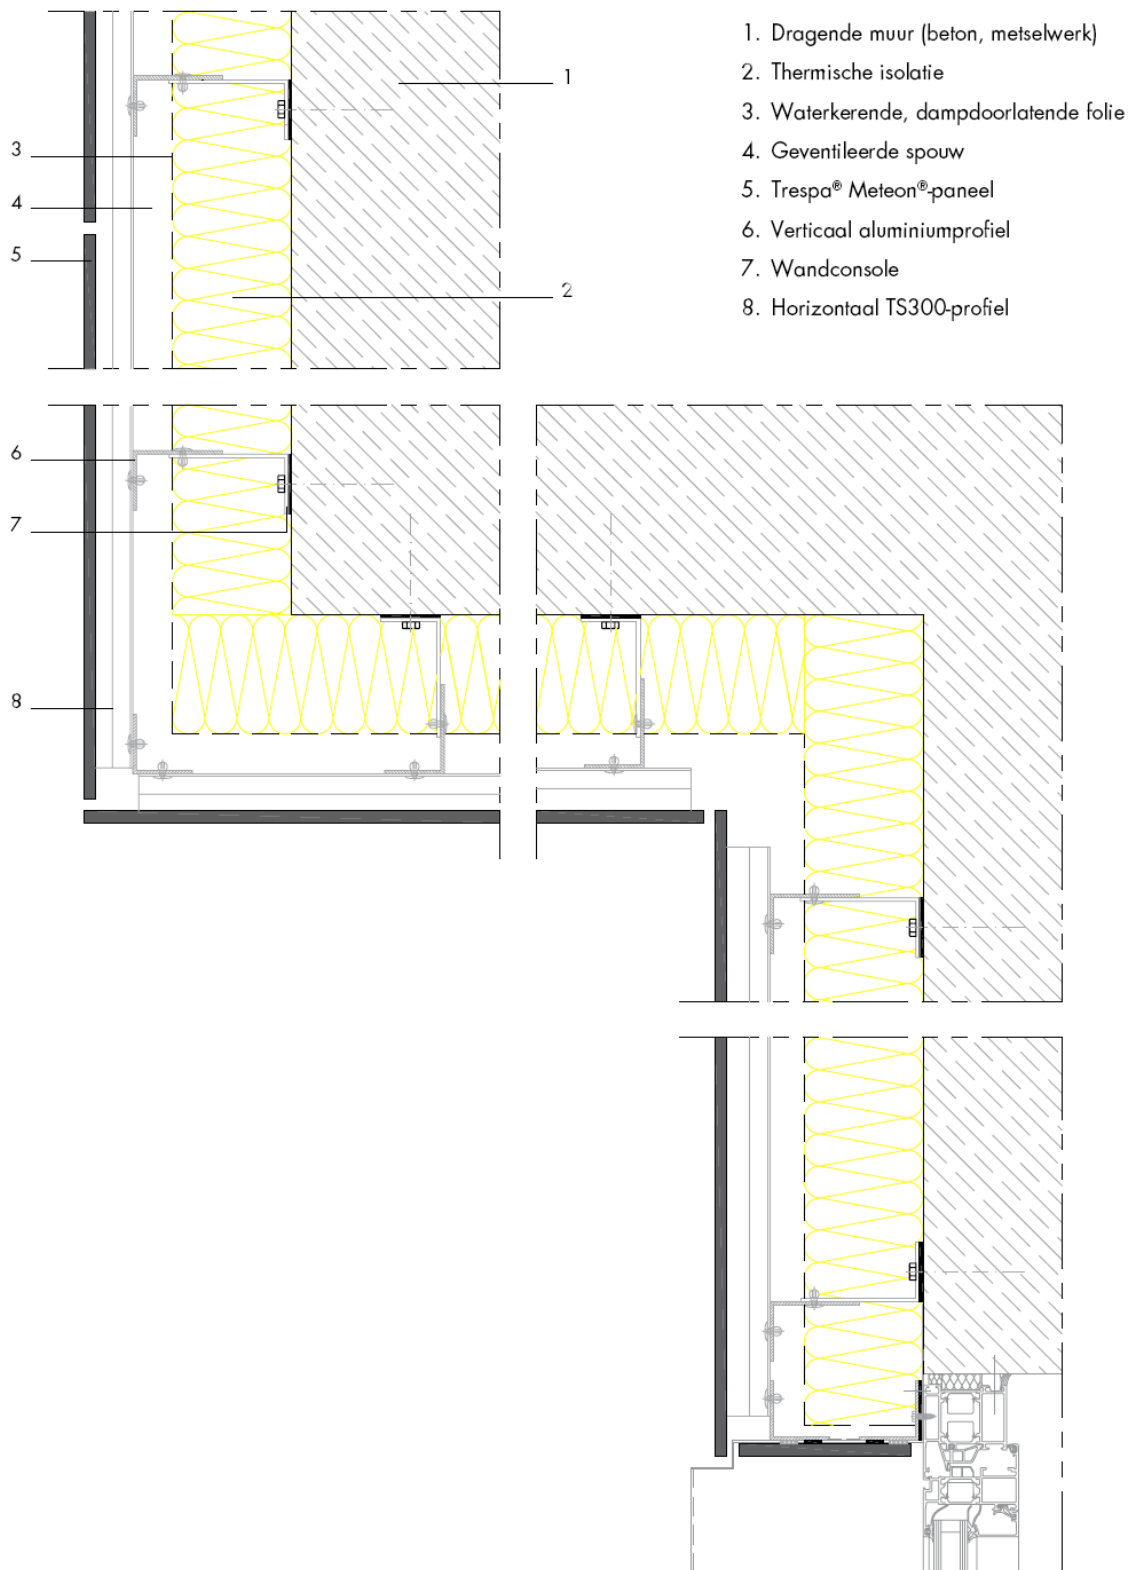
verticale snede van de paneelbevestiging met modulair systeem (geprofileerde randen)
